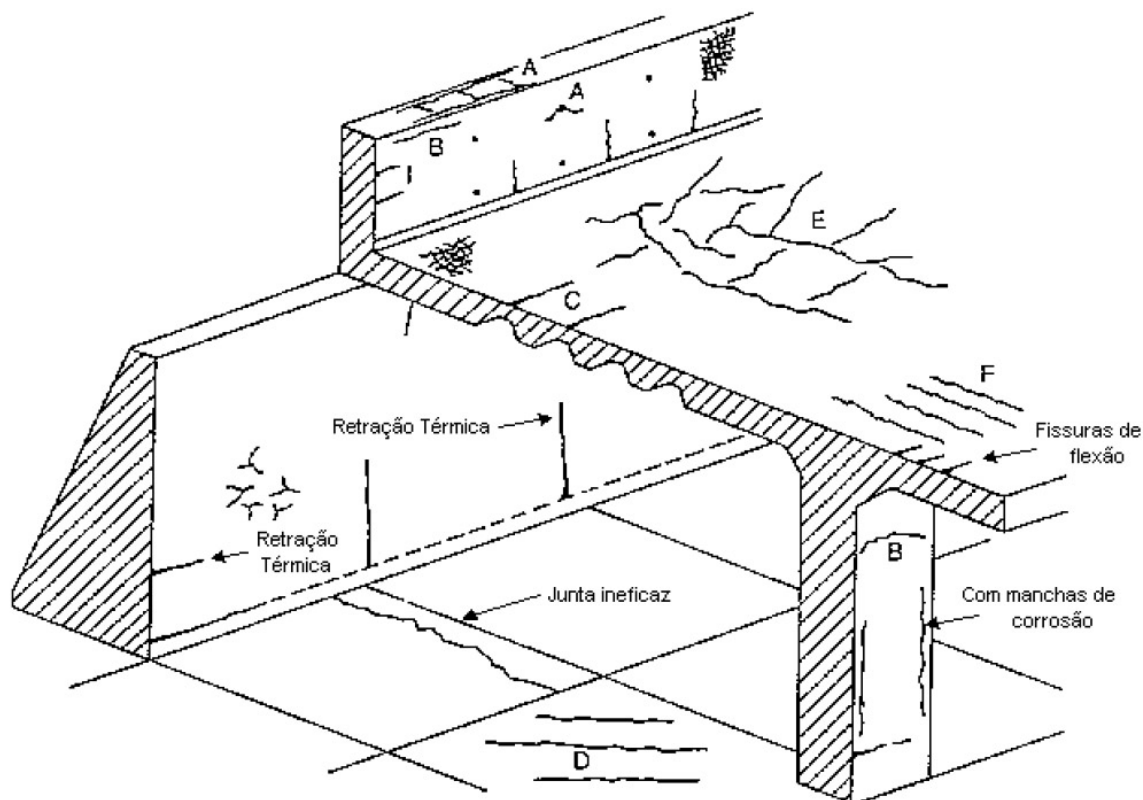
Tipos de Fissuras. Fonte: CEB (1985).
